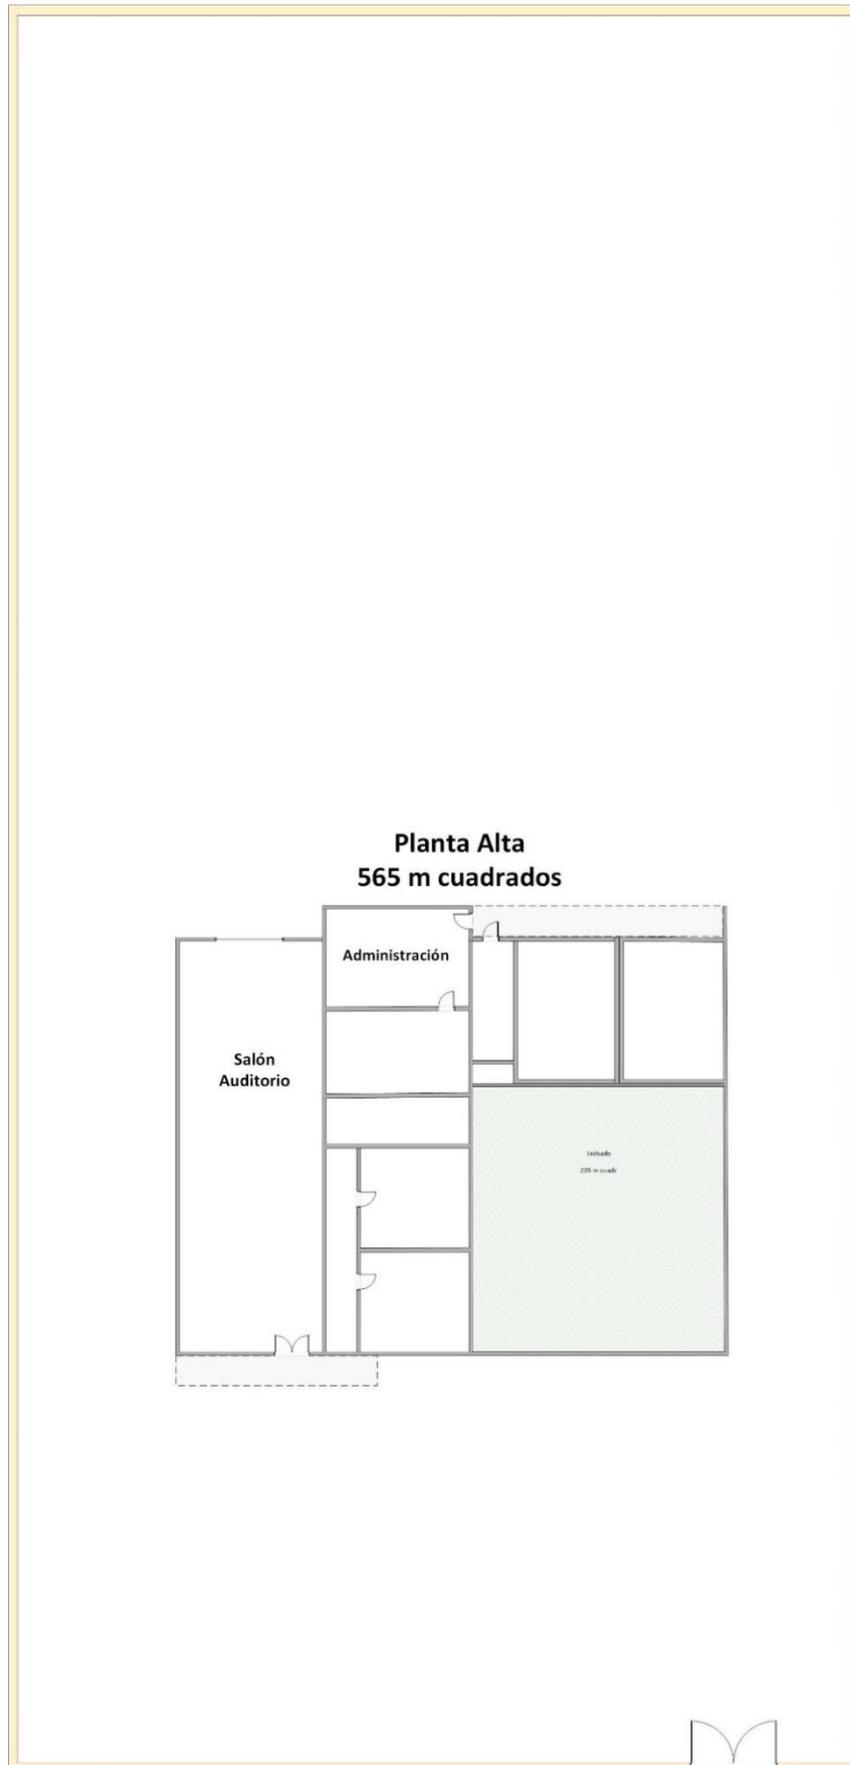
Diseño General de la Estructura de Hotel, Planta Alta.
